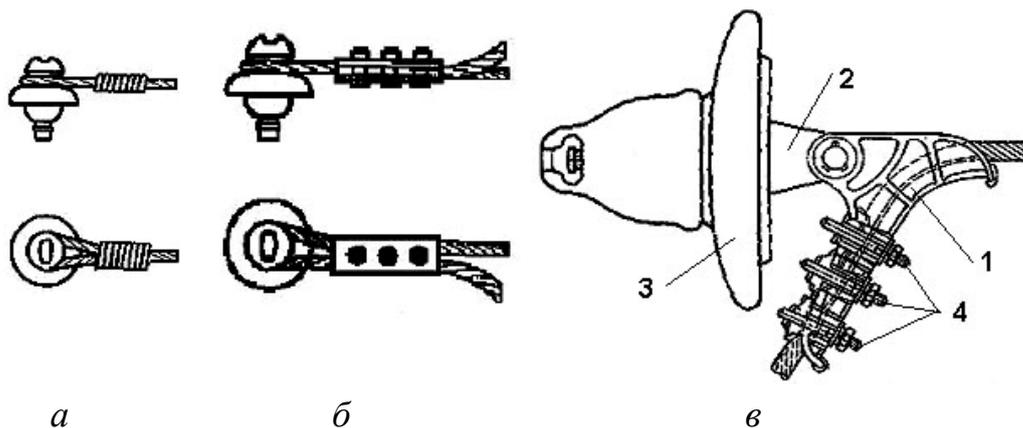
Крепление проводов на анкерных опорах со штыревыми изоляторами (а, б); с подвесными изоляторами (в)
